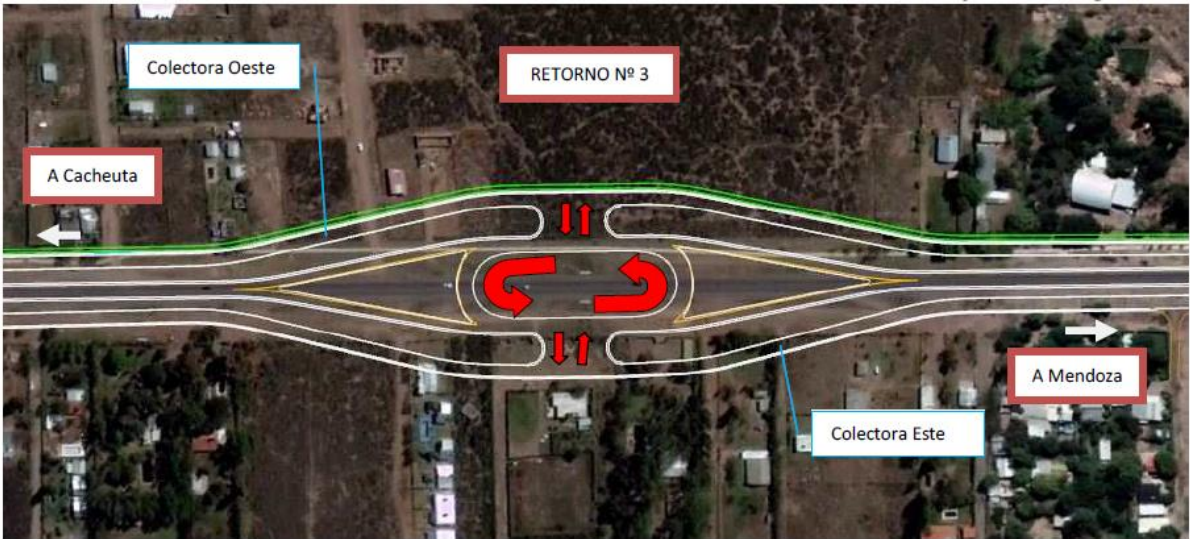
Informe de Ingeniería - Planimetría intersección Roque Saenz Peña y RP N° 82
